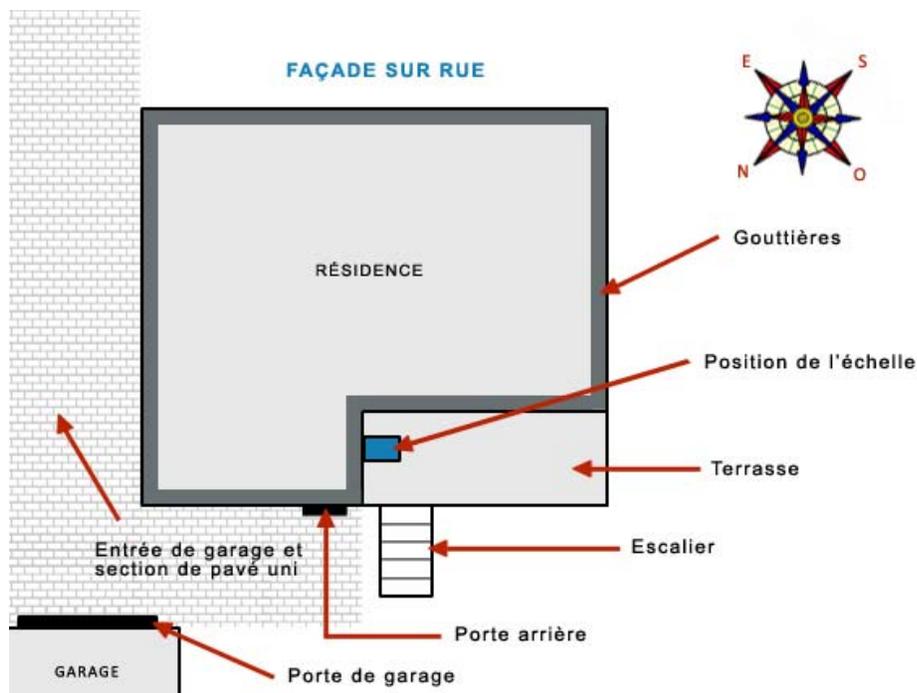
Plan d'aménagement de la maison (source : CSST)
